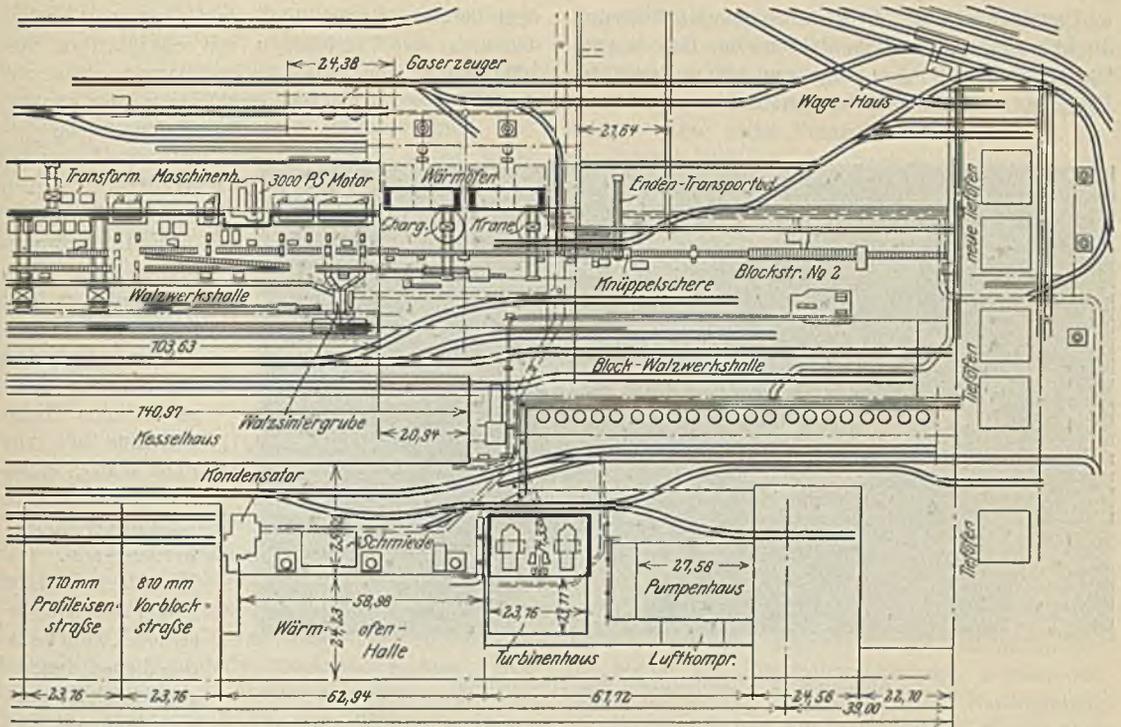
Lageplan des Trägerwalzwerks der Illinois Steel Company.
